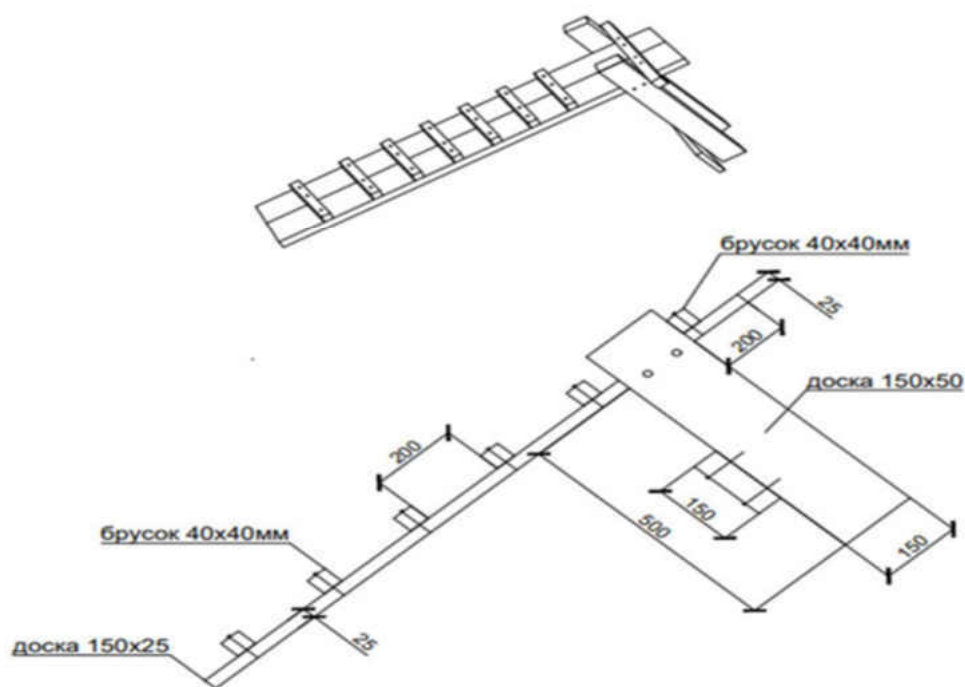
Вариант устройства ходовых трапов на кровле
